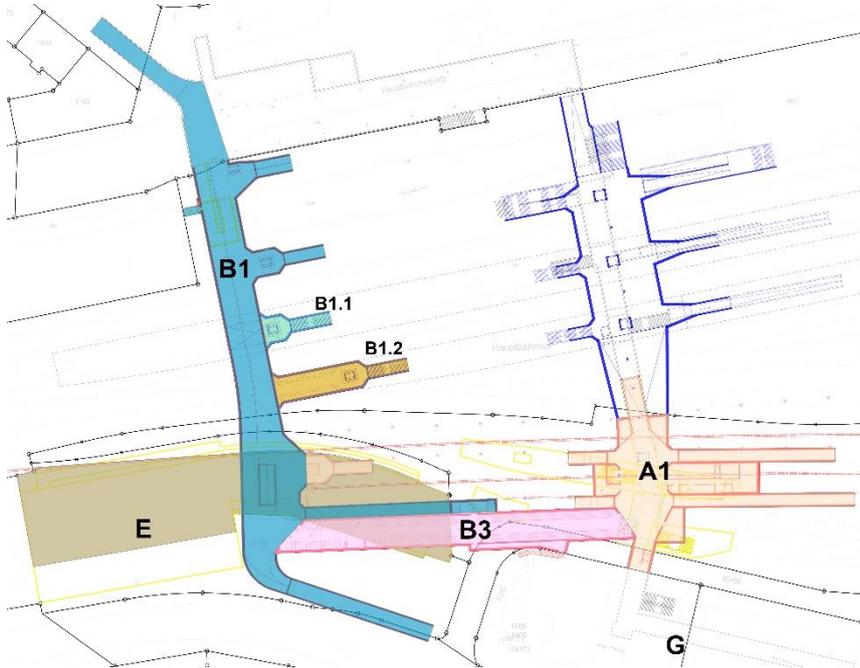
; Planausschnitt Situation auf Ebene Untergeschoss mit Darstellung der Module
